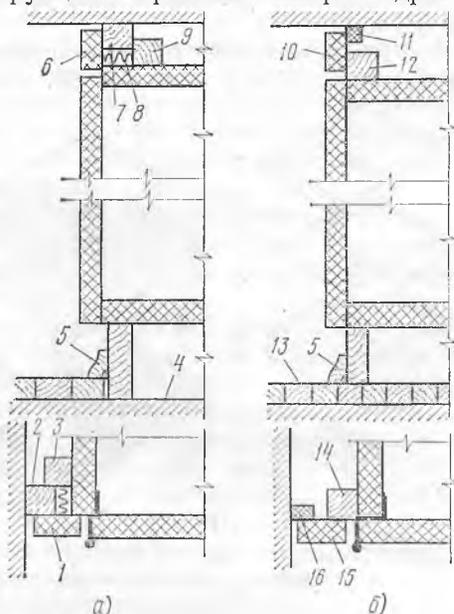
Схема примыкания шкафа-перегородки к элементам зданий:
